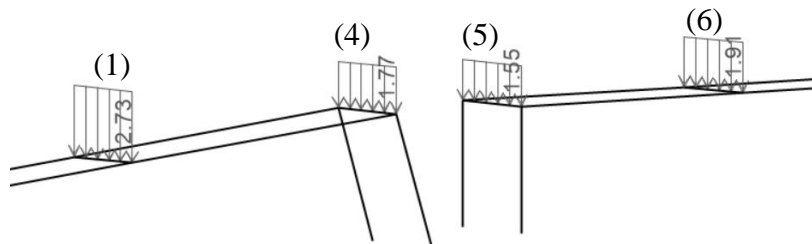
Restante Carga Permanente nas Travessas na ligação dos Troços Inclinado e Horizontal
